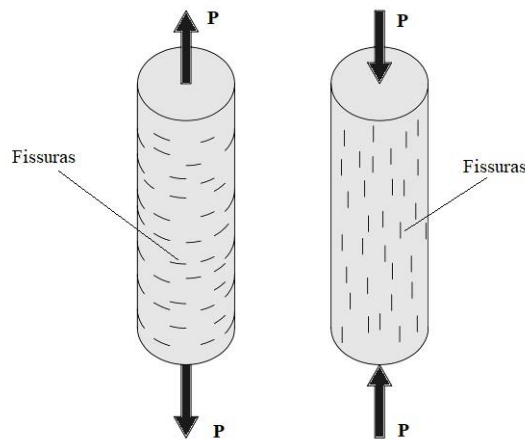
Fissuração uniaxial do concreto para cada tipo de solitação – Fonte: O autor
